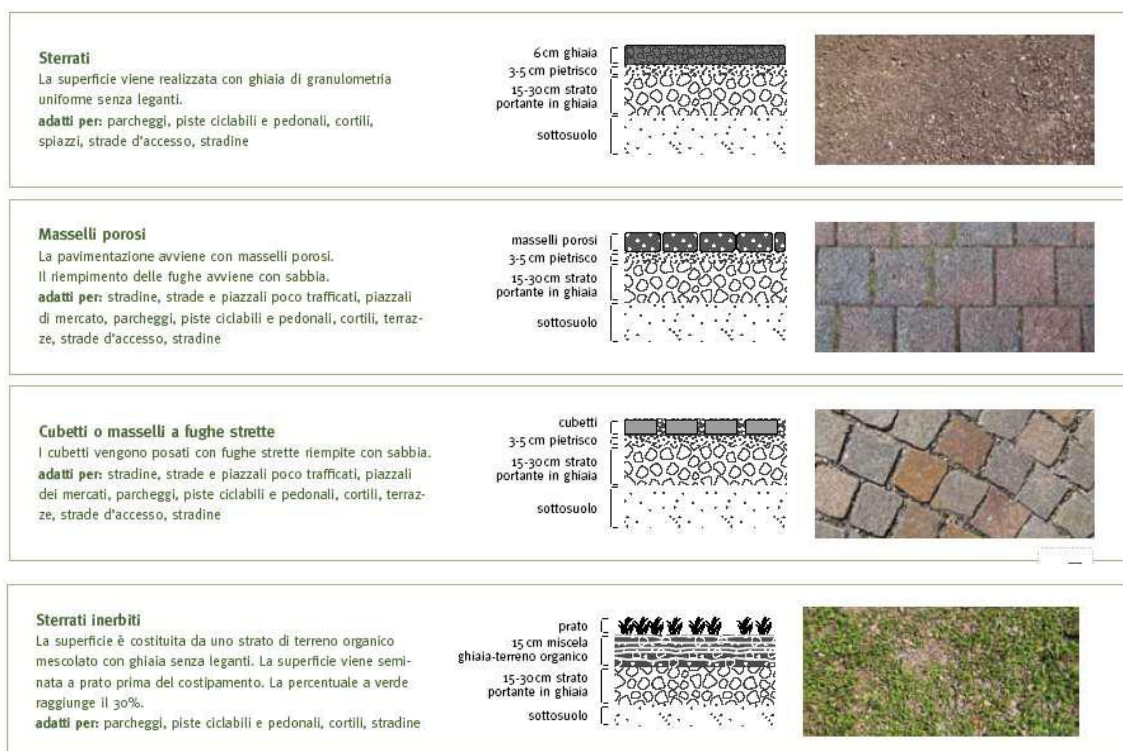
Tipologie pavimentazioni porose [<http://www.provinz.bz.it>]
